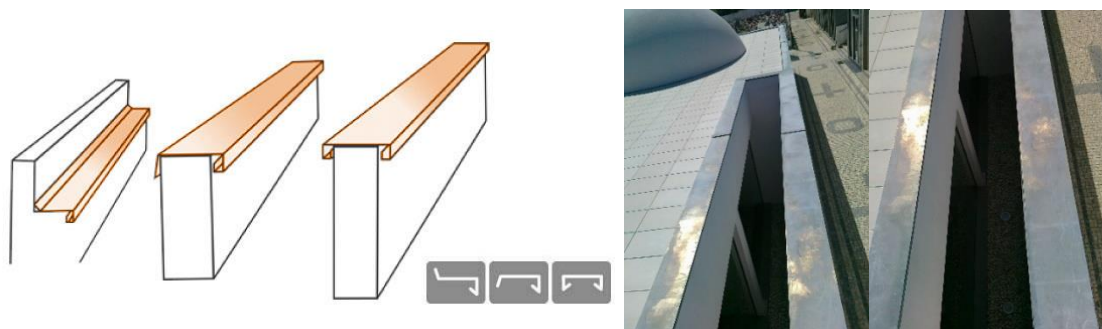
Exemplo de aplicação de funilaria (Obra Casa Mortuária de Lavra)
